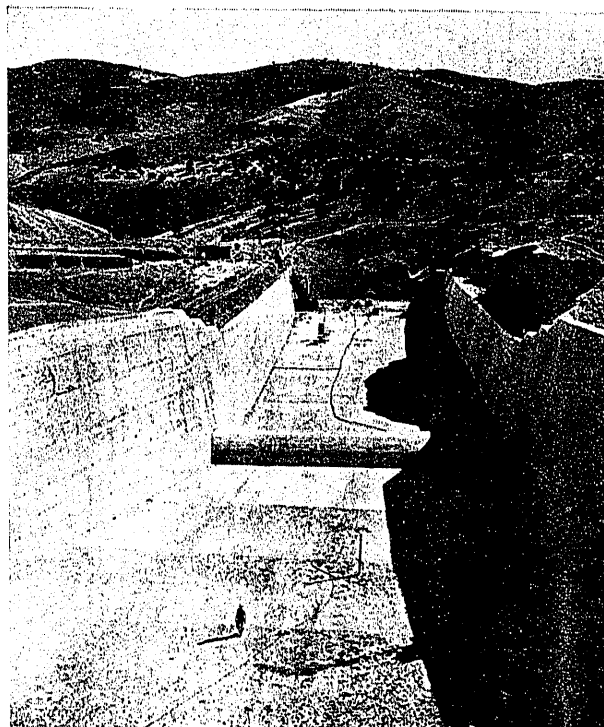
Presa del Pintado*. Aliviadero durante la construcción.
